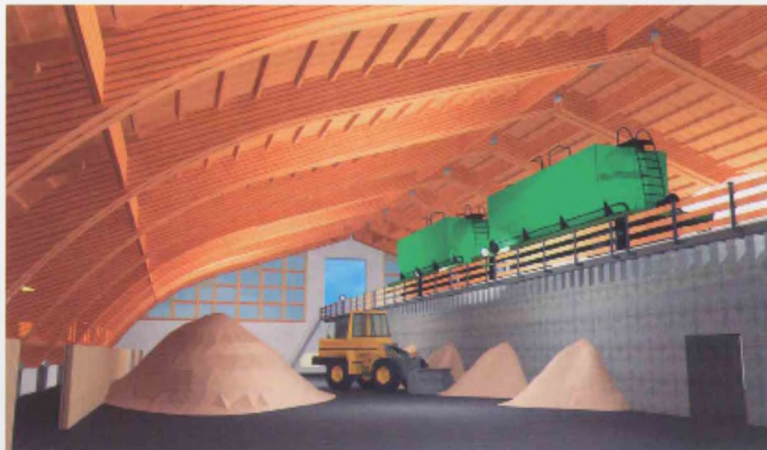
Складское здание для хранения химических удобрений с перекрытием из клееных деревянных конструкций
